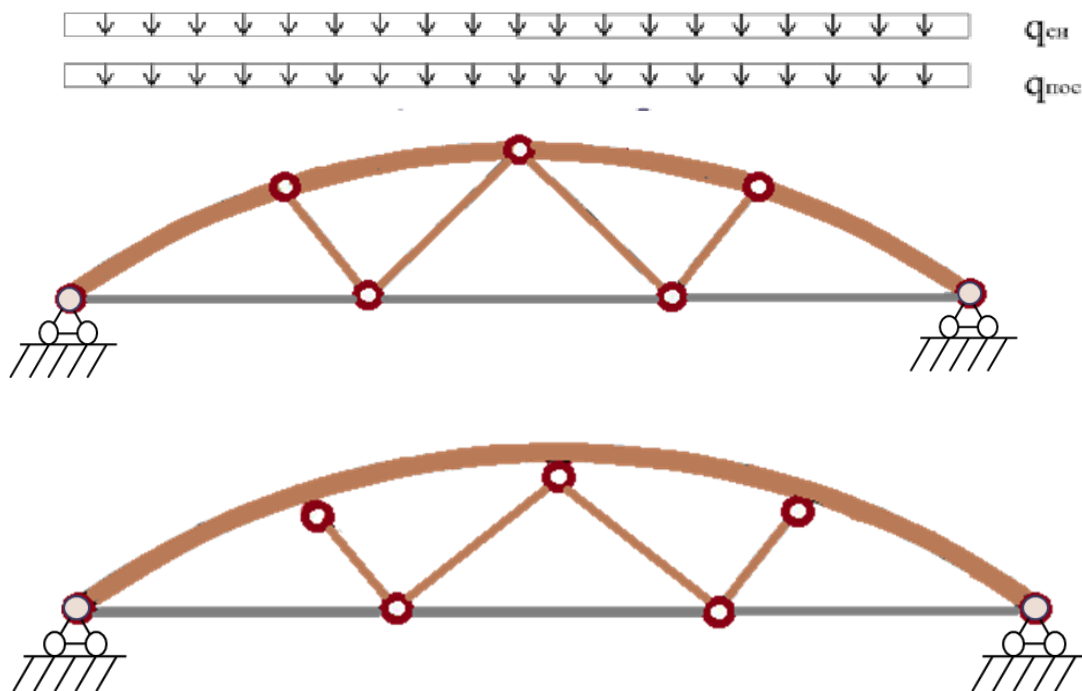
Расчетные схемы ферм сегментного очертания с разрезным и неразрезным верхним поясом
